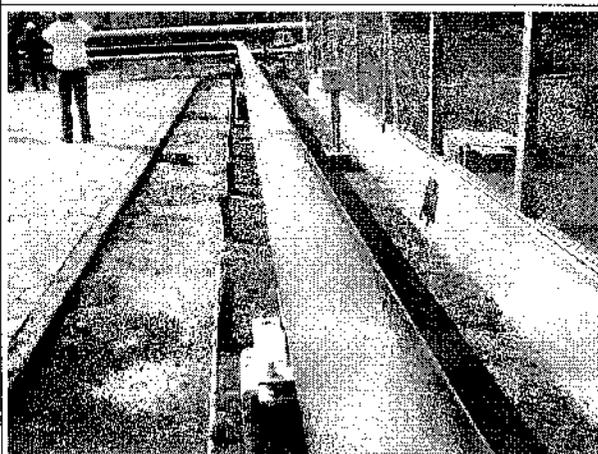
PE REVAP II; tubulação de saída para a refinaria. Pavimentação de bloquetes e grama.
